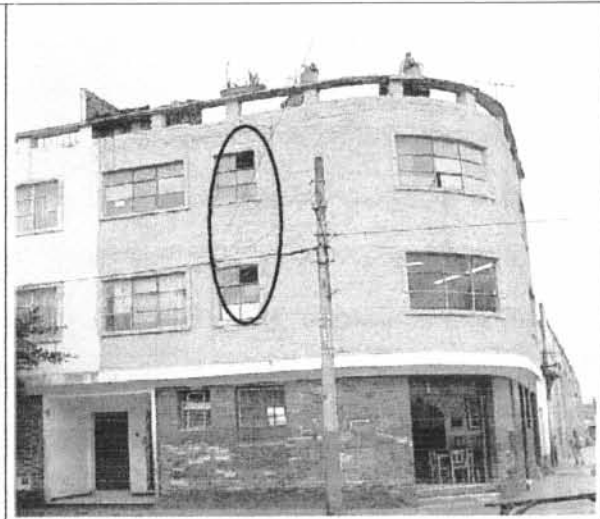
La fachada de la edificación fue pintada recientemente. Hay rotura de vidrios.
